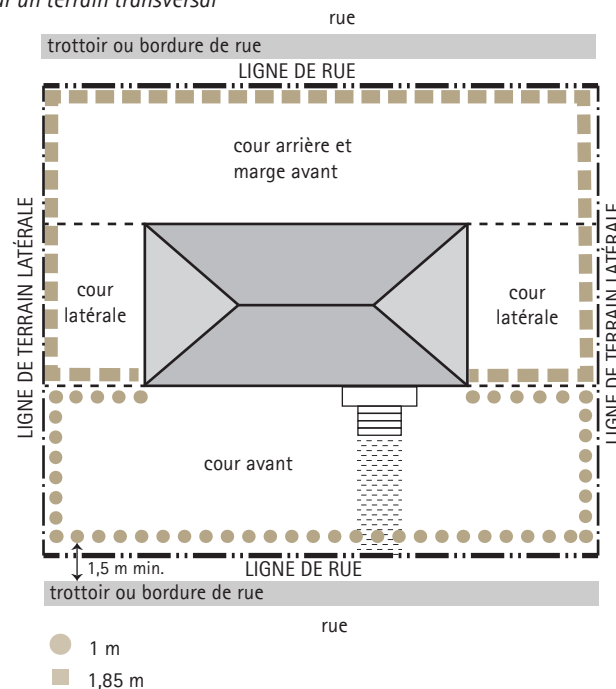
Emplacement et hauteur maximale d'un mur ou d'un muret sur un terrain transversal
